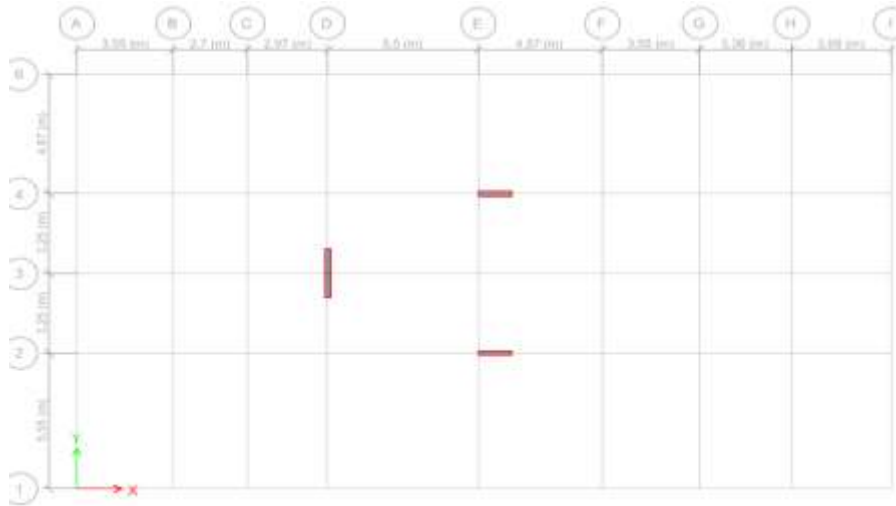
Disposition des voiles de contreventement au niveau de la terrasse
